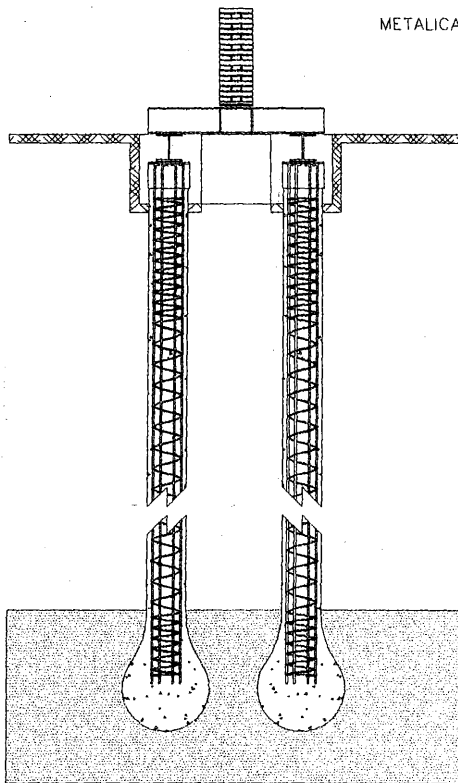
Recalce profundo de cimentación superficial mediante pilotes contruidos "in situ" y encepado de viga pasante:
